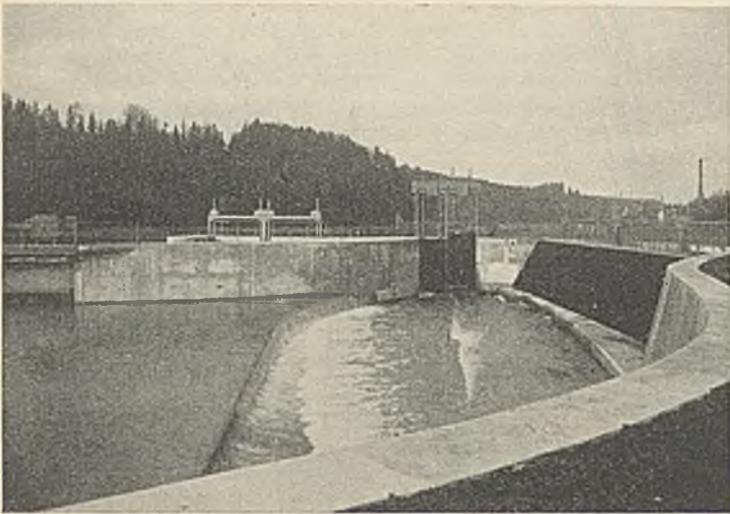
Einlauf mit Ablagerungsbecken und Spülschleuse.
